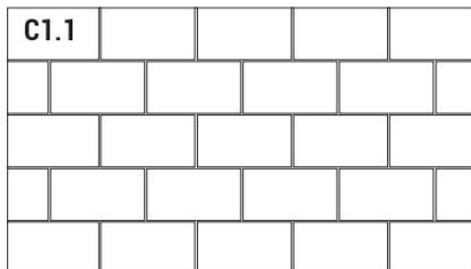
Abaco delle murature sbazzate - Pietra lastriforme - Pietra pseudo regolare [14]
